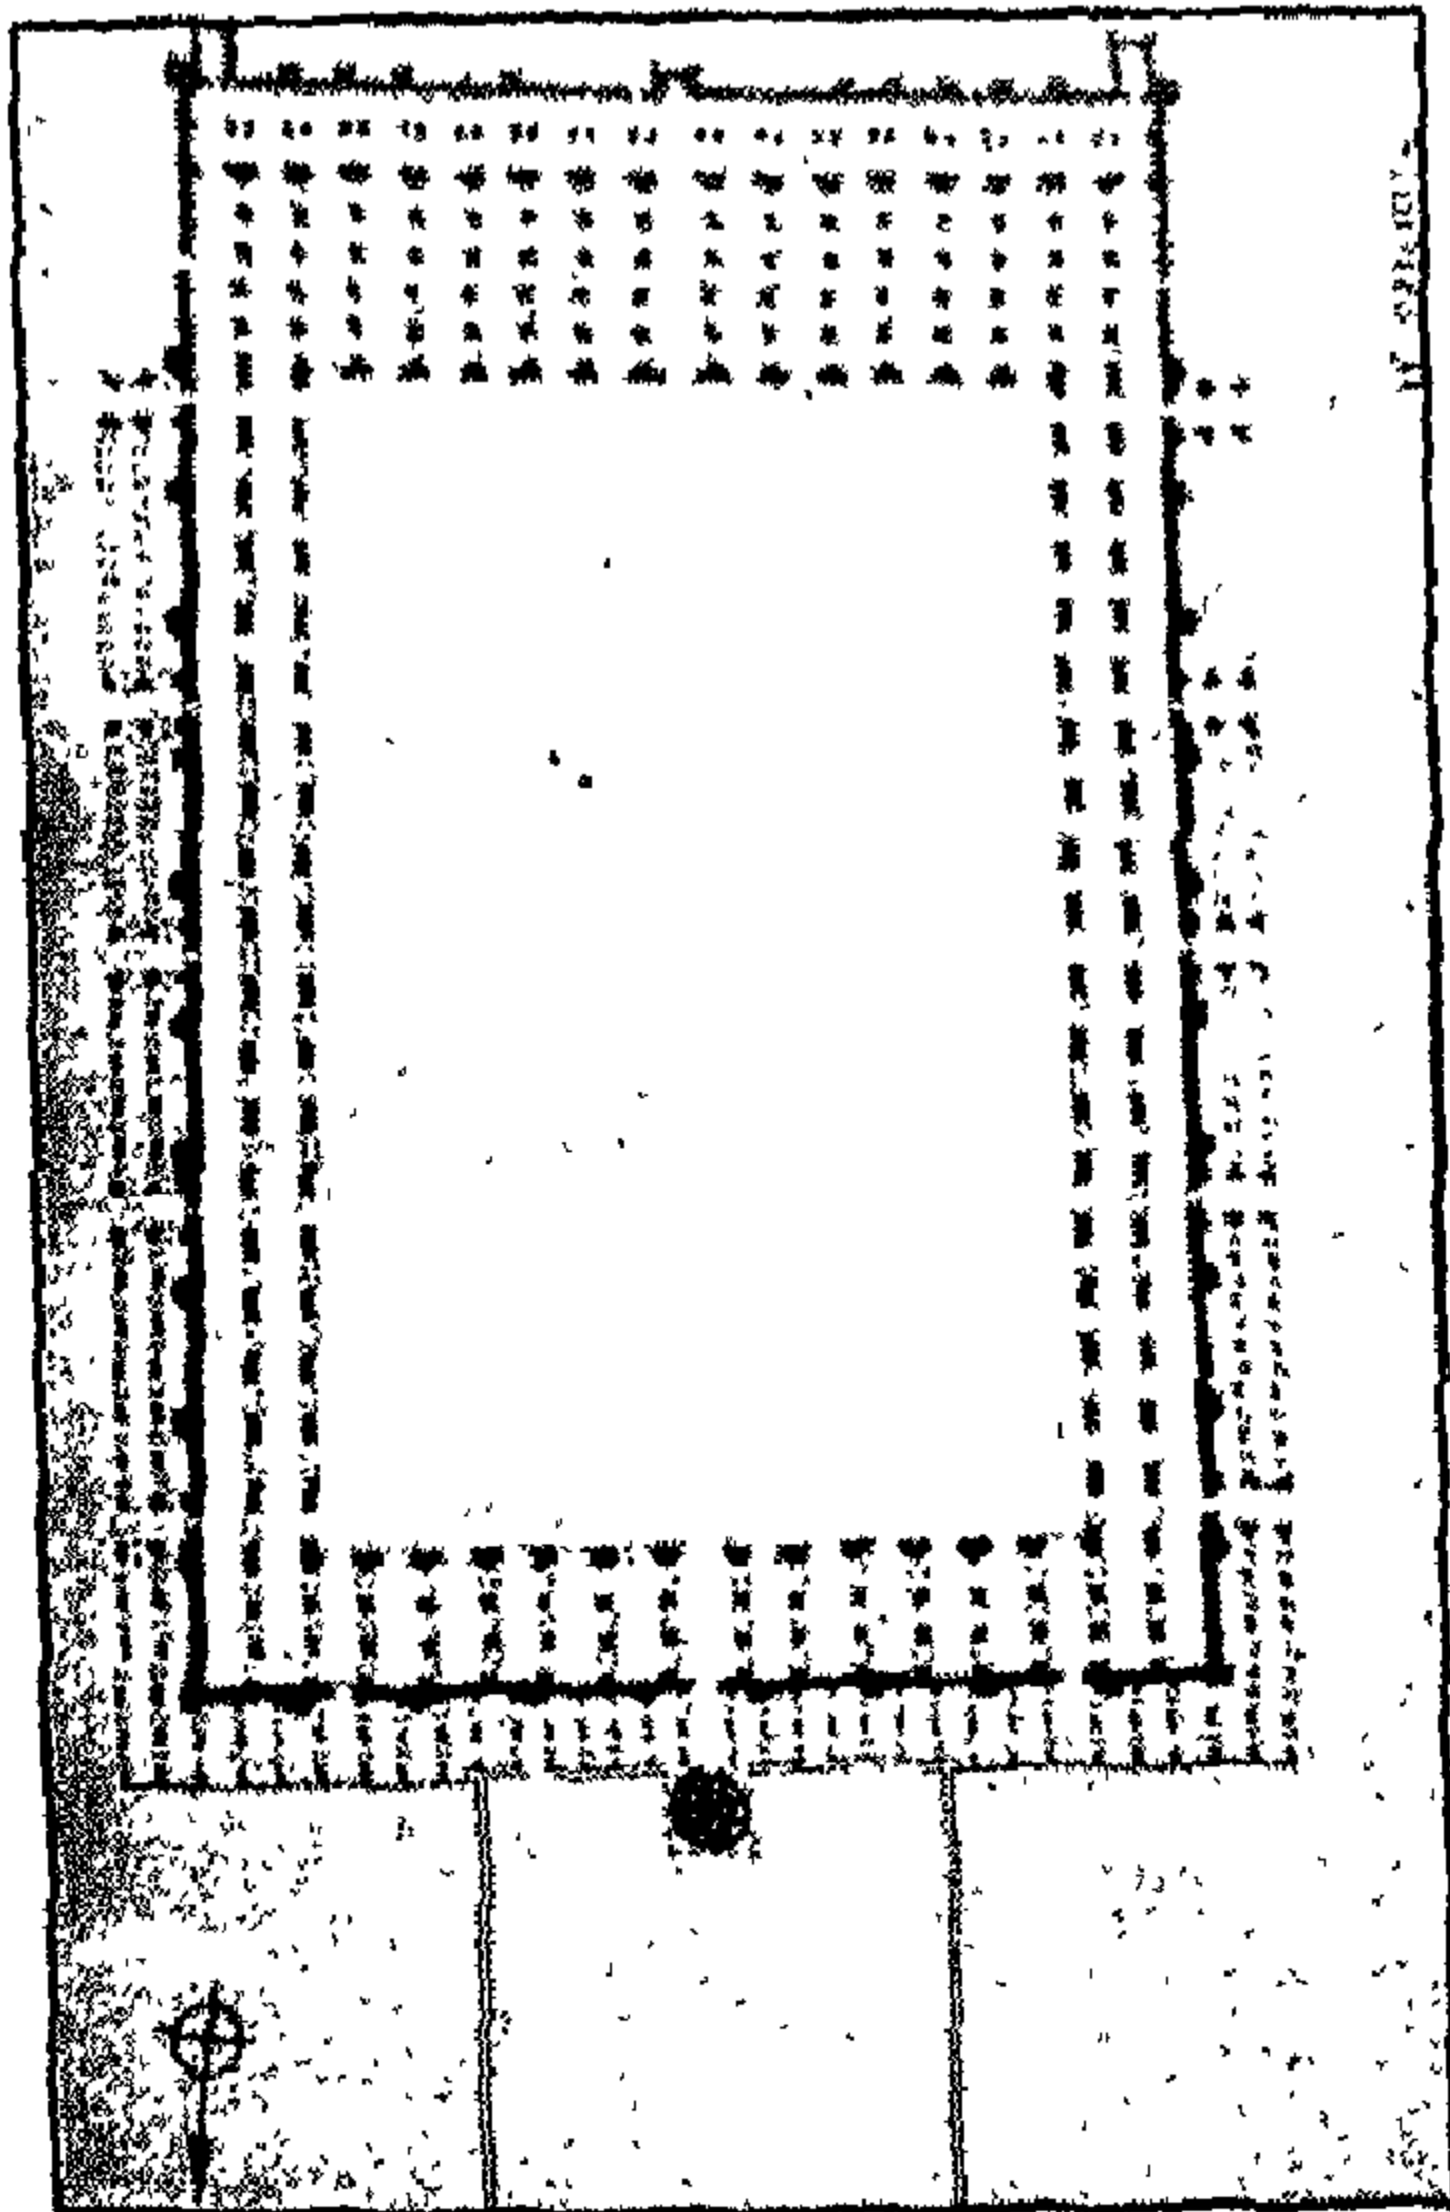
الجامع الأقصى الحالي (مسقط أفقي)
